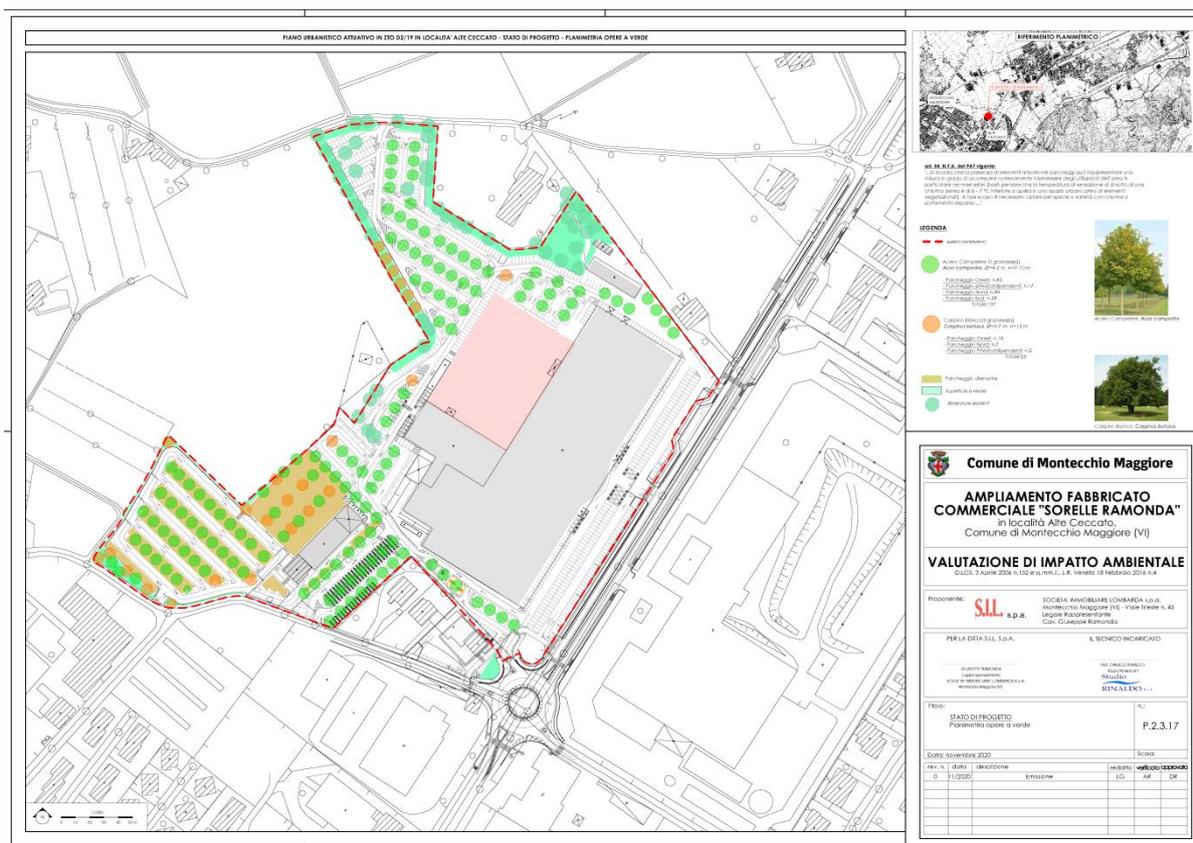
tavola P.2.3.17 - Stato di Progetto - opere a verde
